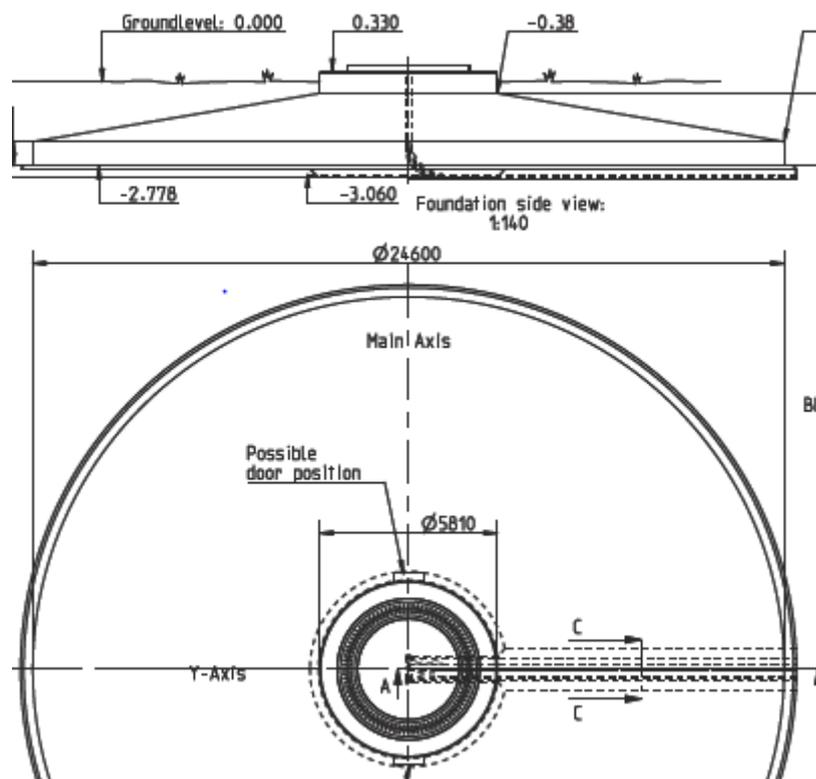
Schema tipologico delle fondazioni per le turbine di progetto
